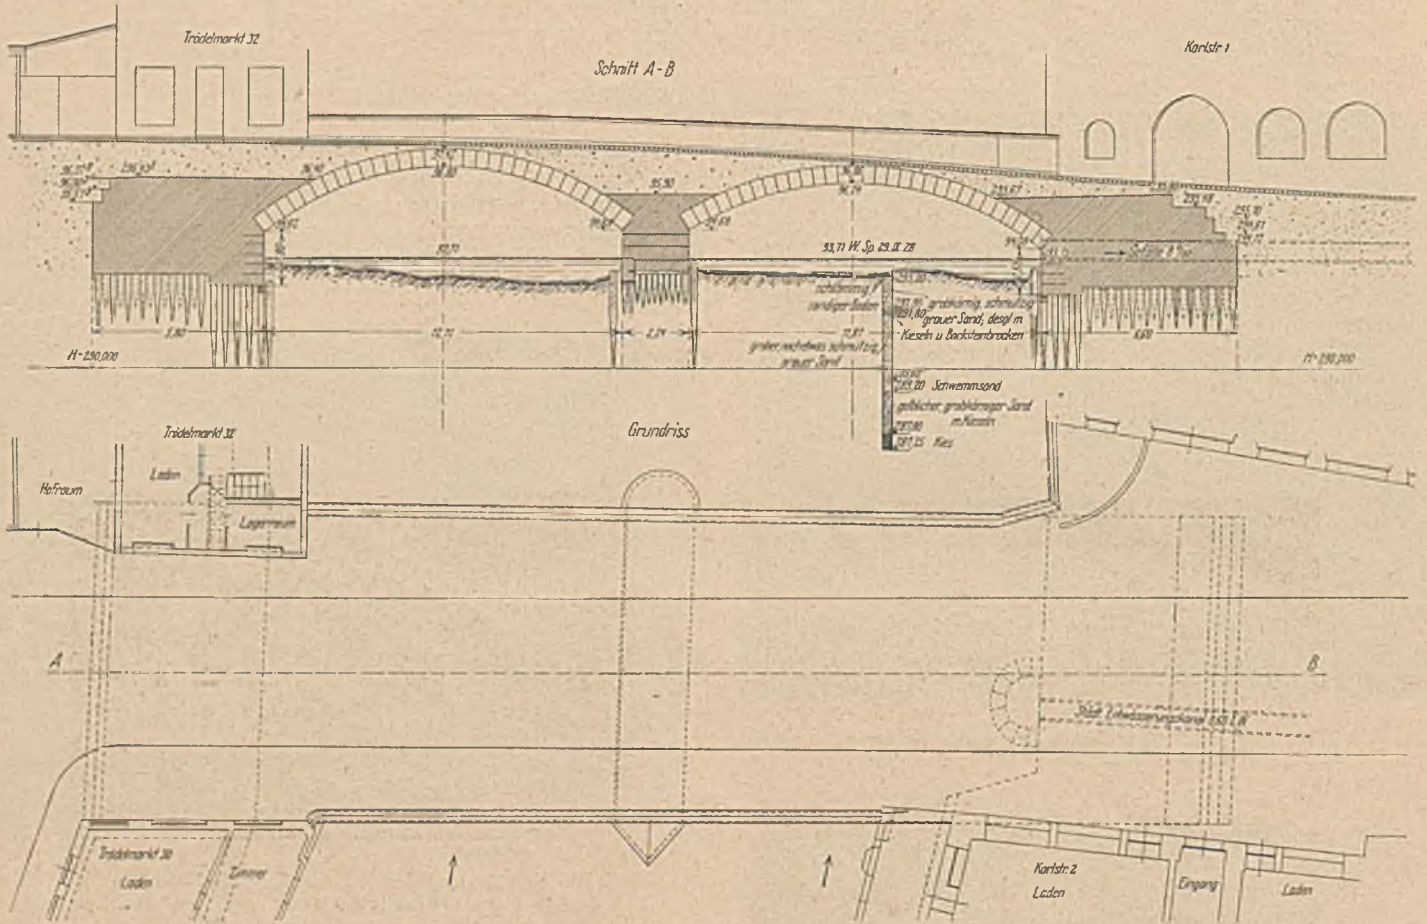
Längenschnitt vor dem Umbau. Grundriß vor und nach dem Umbau unverändert.
